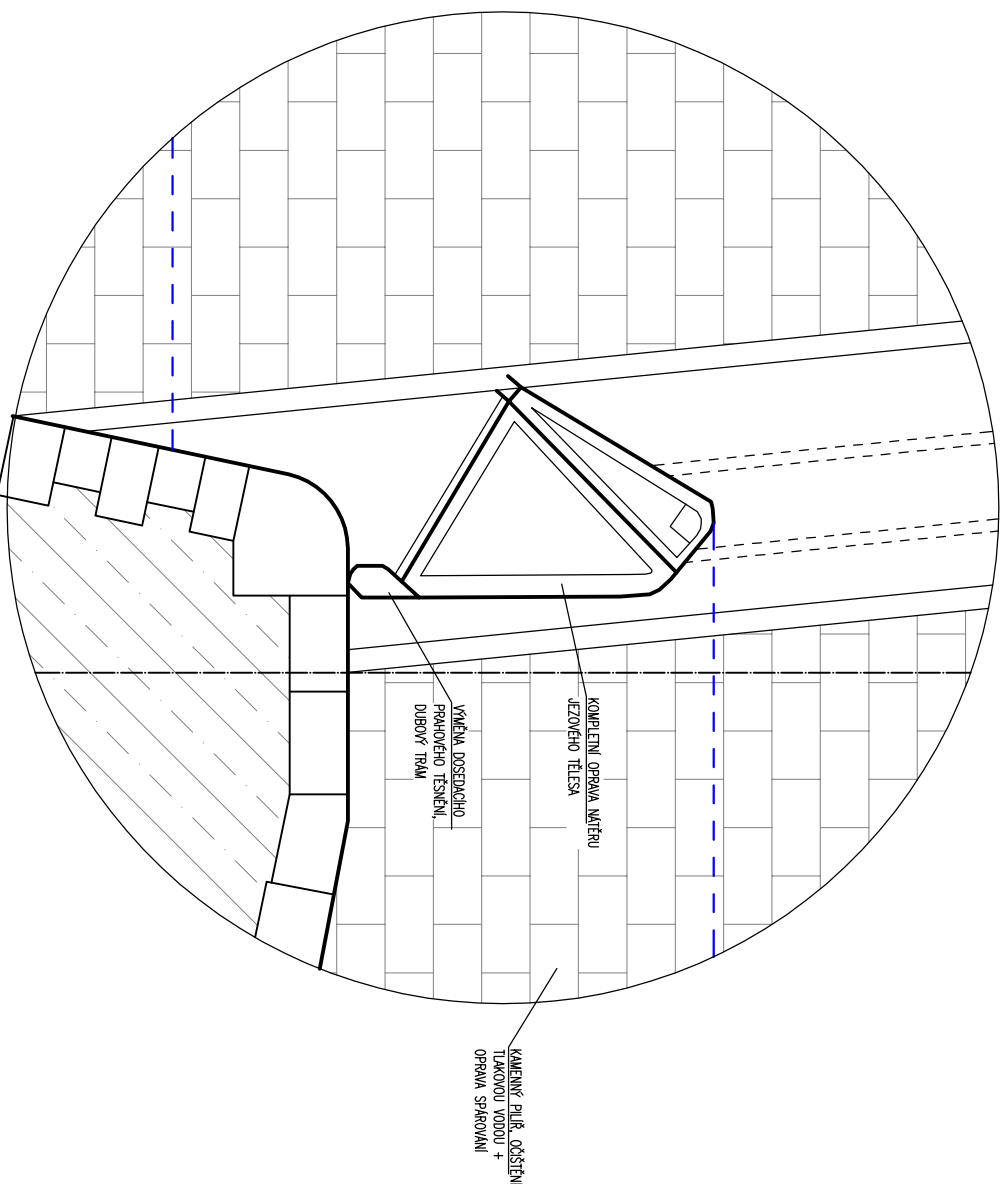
## DETAIL PRAVÉHO JEZOVÉHO TĚLESA
